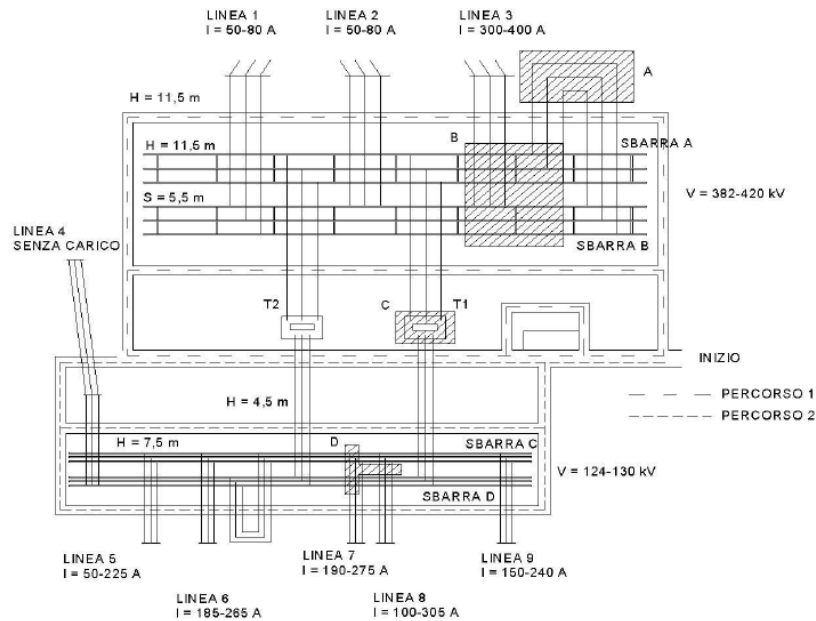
Pianta tipiche di una stazione 380/132 kV di Terna con indicazione dei punti di misura
